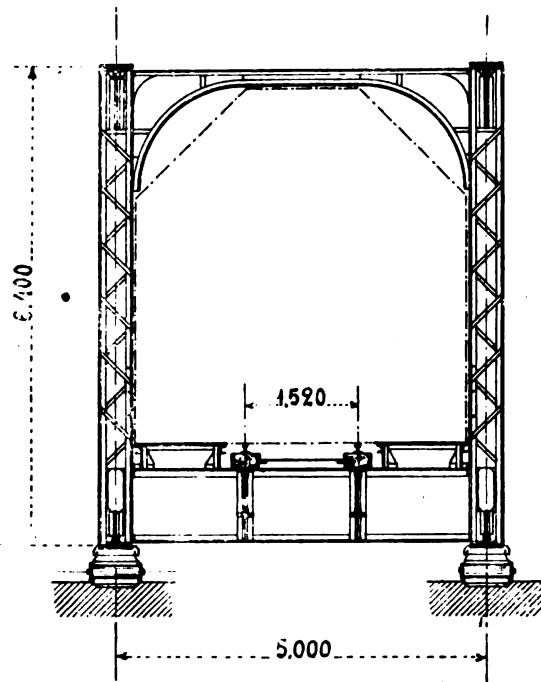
Sezione trasversale di una travata del ponte sul vecchio alveo del Livenza.
